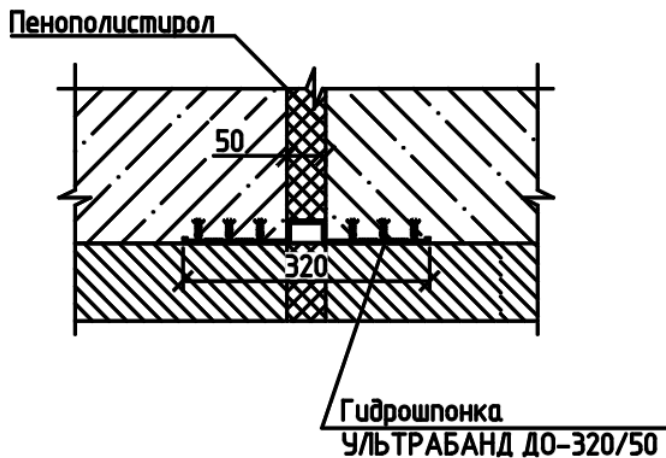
Герметизация деформационного шва монолитной железобетонной фундаментной плиты с применением гидрошпонки ДО-320/50
